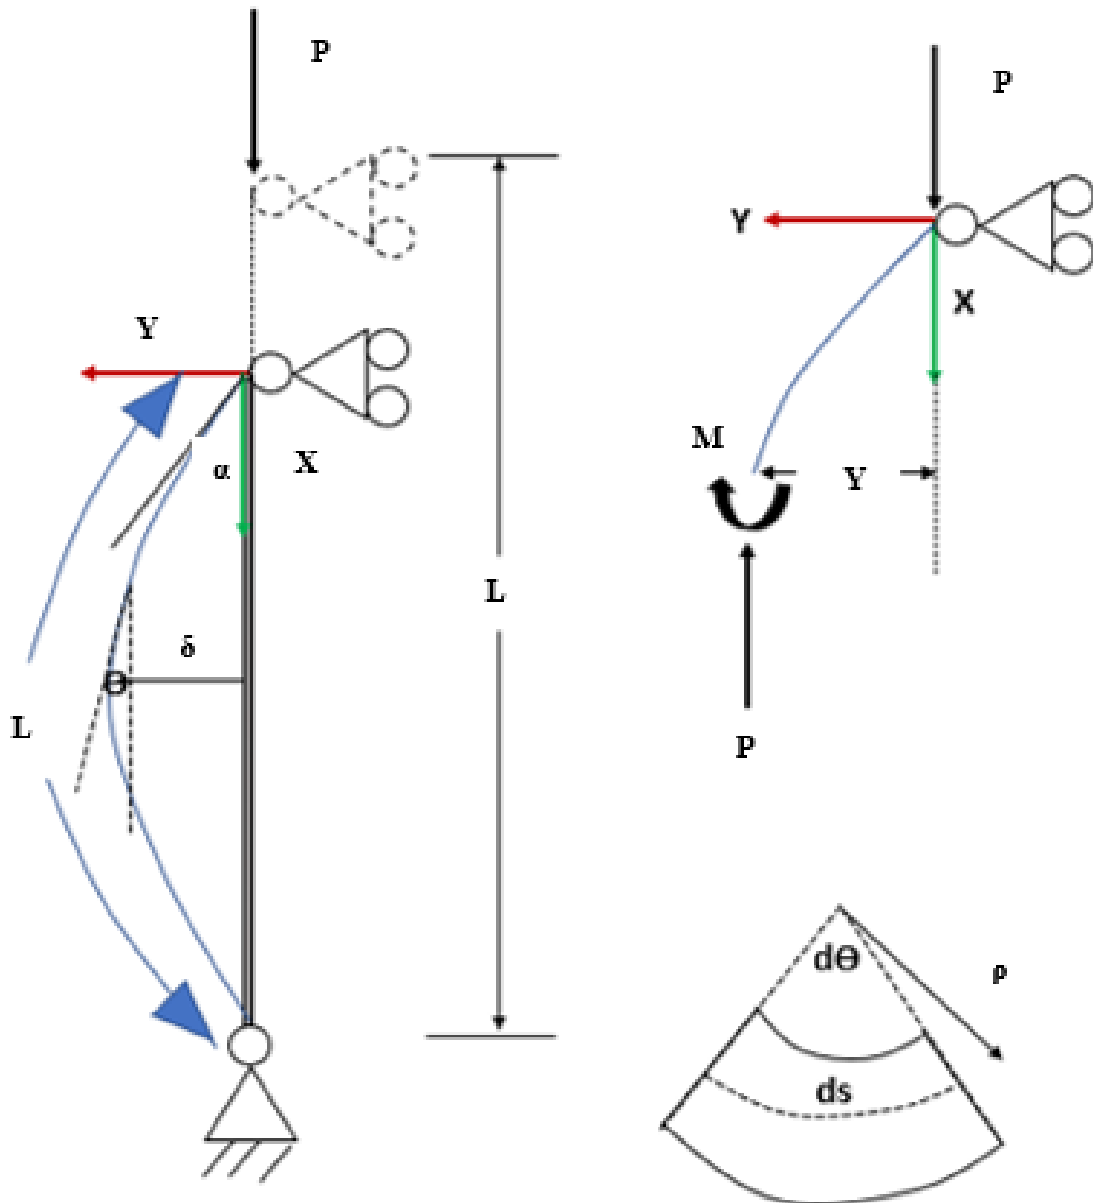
Columna doblemente articulada bajo deformación no lineal.
